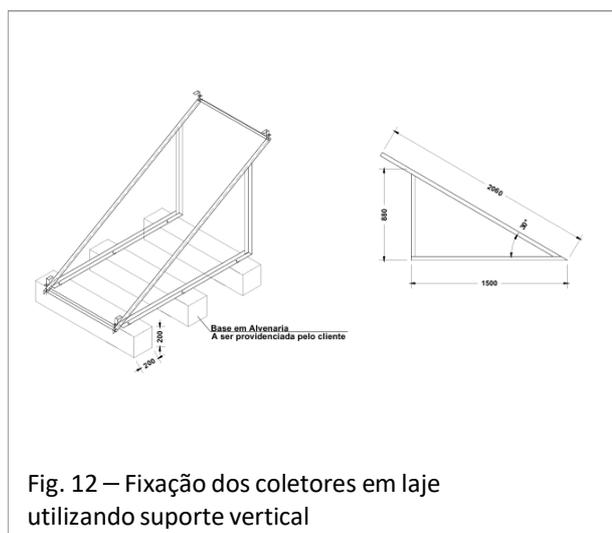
Fixação dos coletores em laje utilizando suporte vertical
